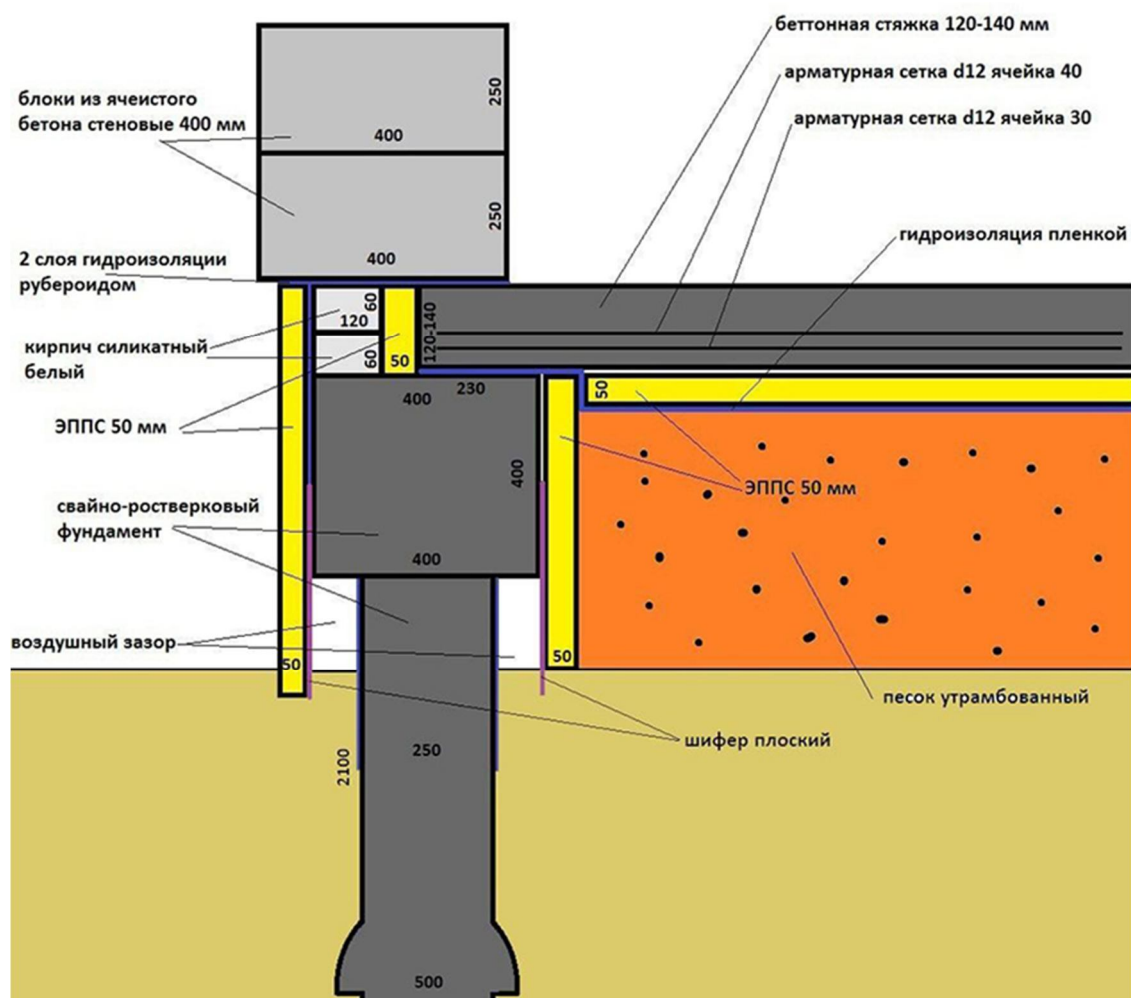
Ростверк со сваями может стать основанием для здания из любого материала
